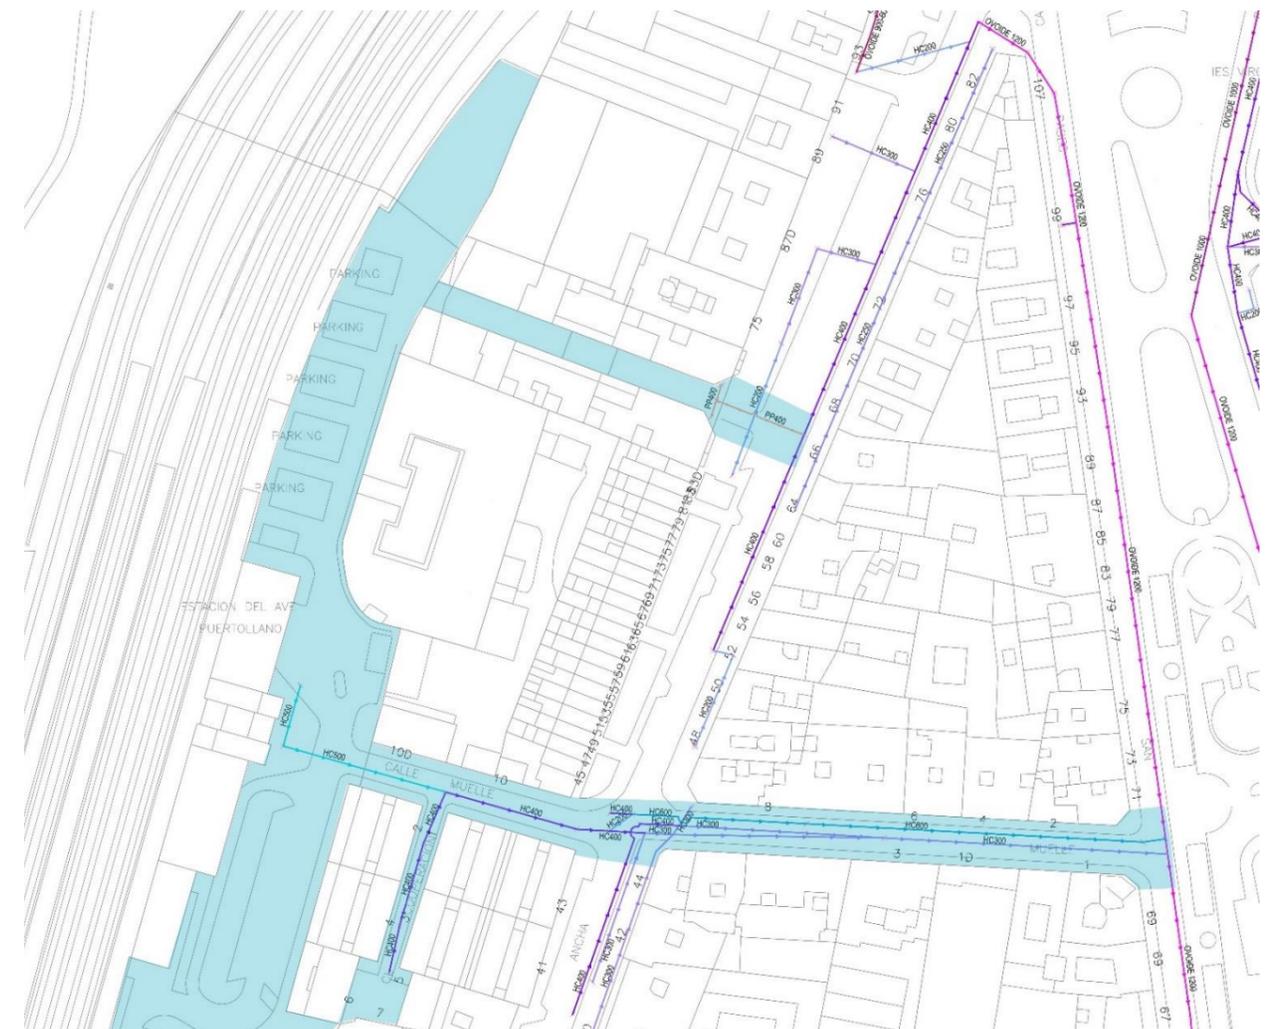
Red de Saneamiento de Puertollano, plano de Abril del 2016. Fuente: Aguas de Puertollano.
